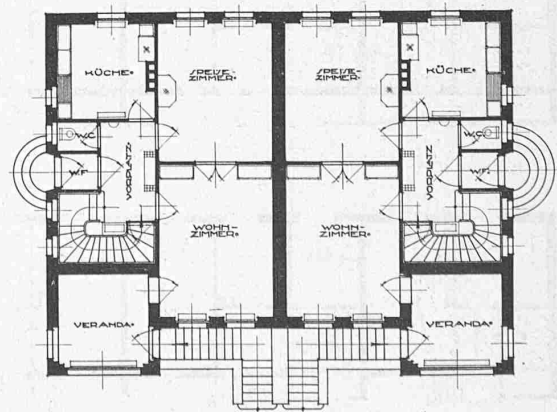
Grundriss vom Erdgeschoss.
